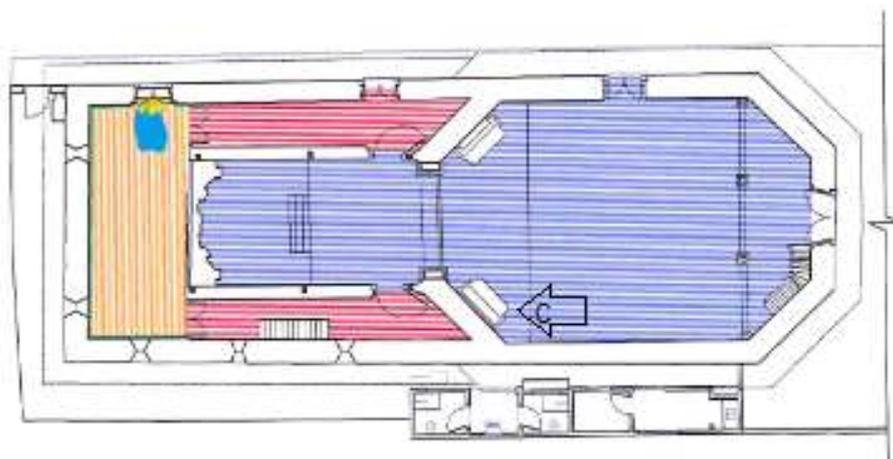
Vista C –Retábulo lateral esquerdo - Planta pavimento inferior Capela Sem escala.
